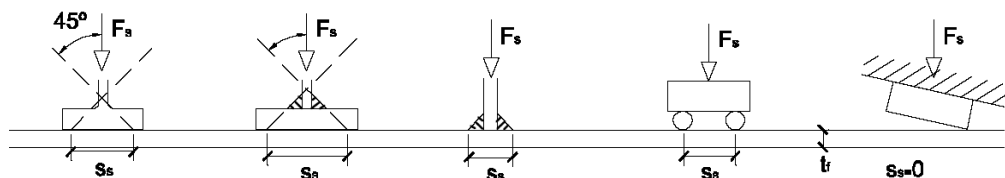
Ancho de entrega rígida en el perfil HEB-400
